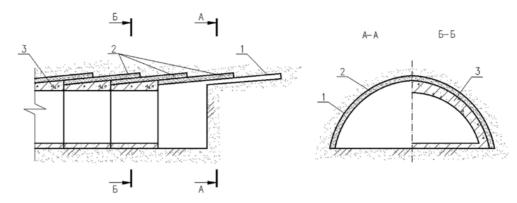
Строительство тоннелей с применением ОБК: 1— контурная щель; 2— бетонное или набрызг-бетонное заполнение; 3— тоннельная обделка
